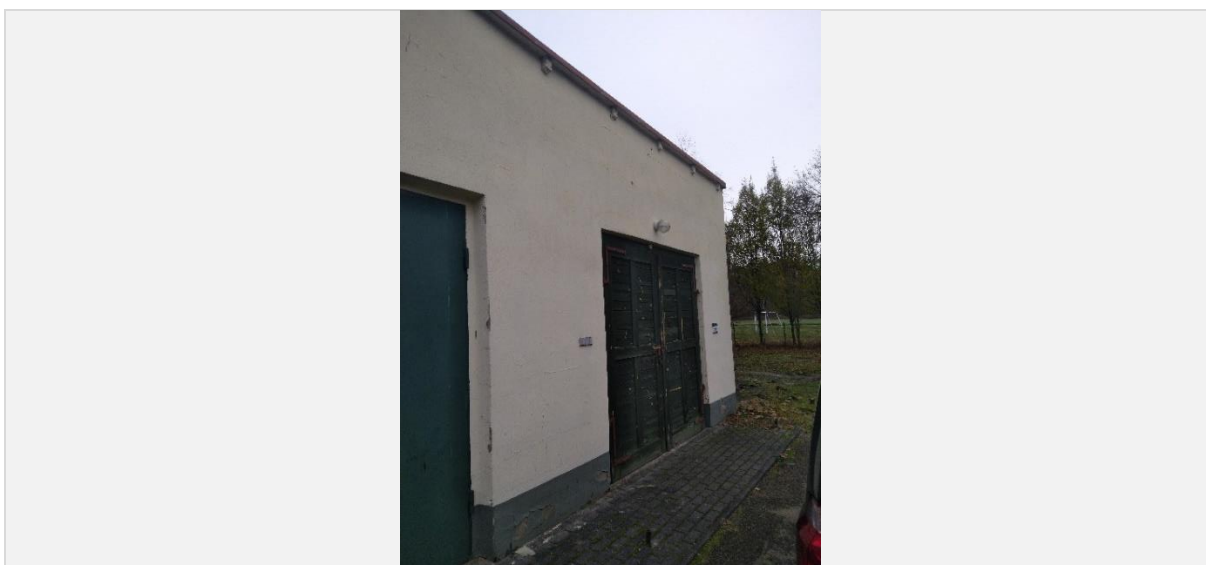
Elewacja frontowa – zbliżenie na zdjęciu - rys. 33
